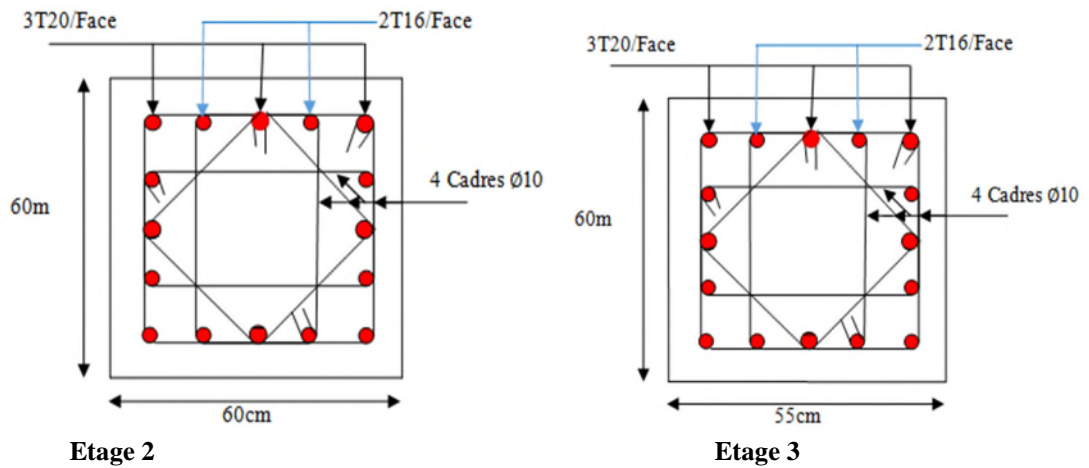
5.Schéma de ferrailage des poteaux des étages 2 et 3
